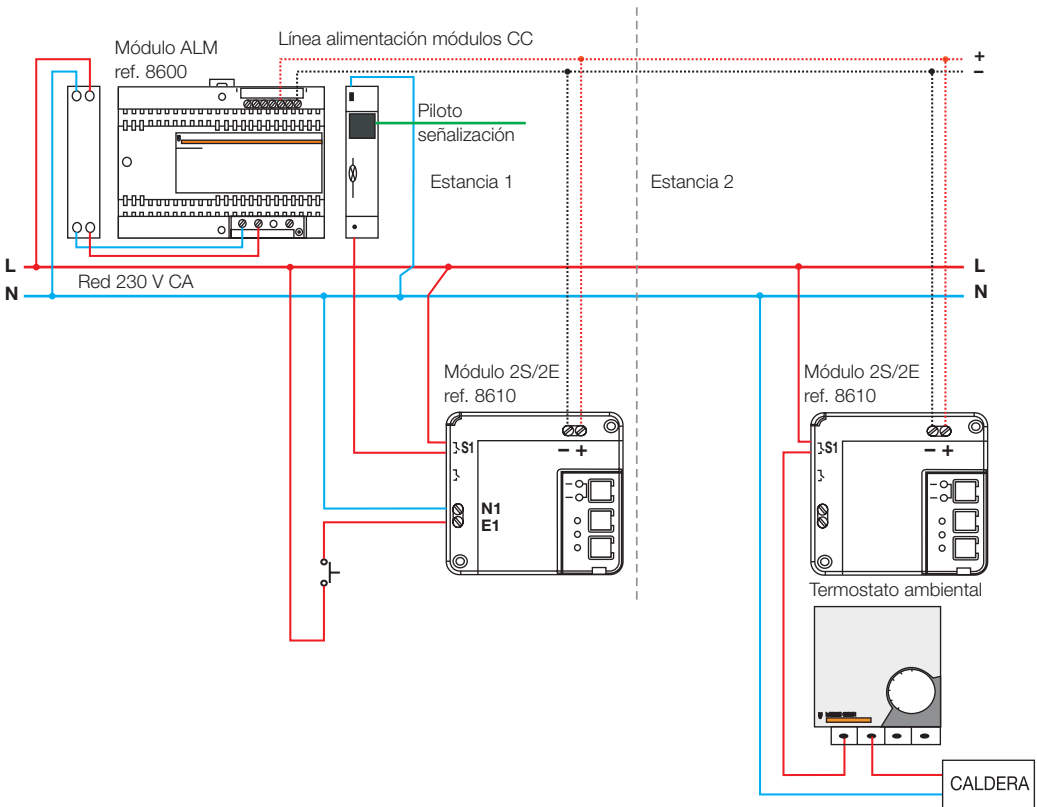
esquema de conexionado para señalar el estado de la calefacción con un piloto en el cuadro de la vivienda.
